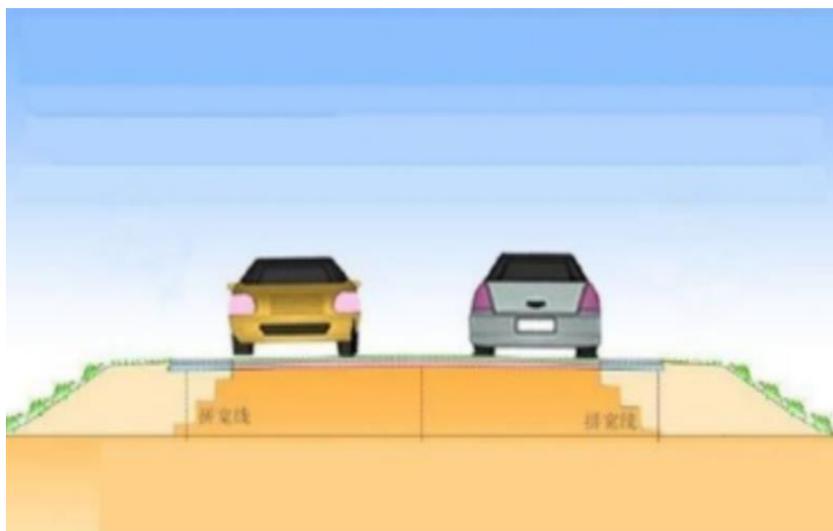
县道路段及金土村海滨路路面结构纵断面示意图
